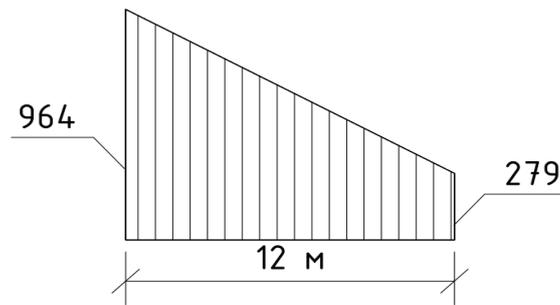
Схема распределения веса снегового покрова в месте перепада профиля кровли
